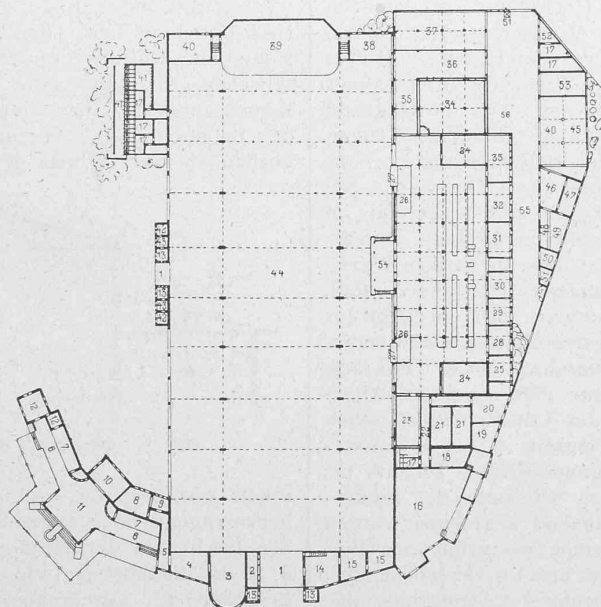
Grundriss der Festhütte. 1:1500.
